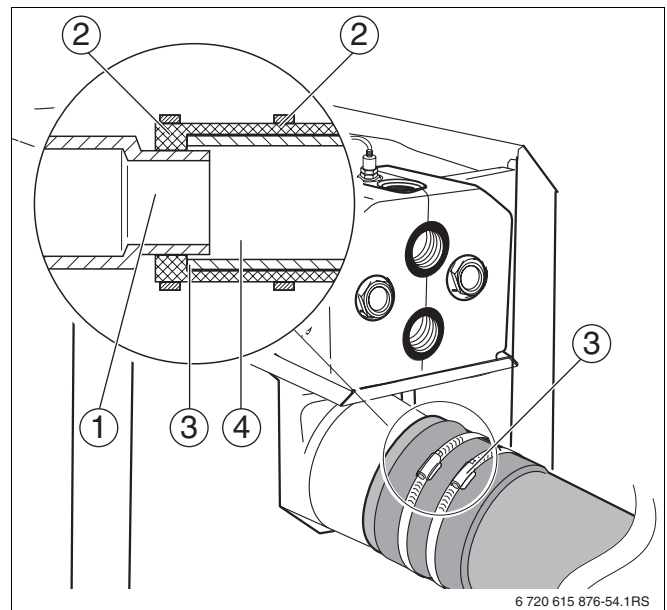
Montaggio del manicotto di tenuta del tubo fumi
